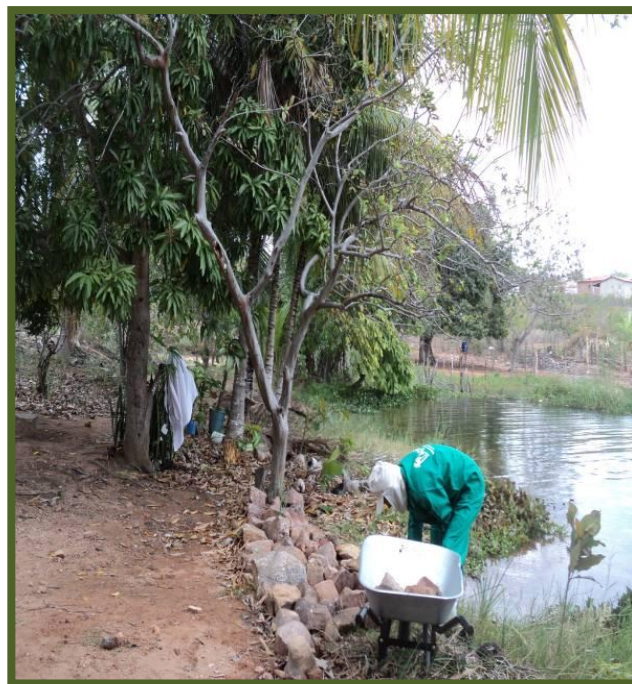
Enrocamento de pedra área 03 em setembro de 2011 (Flávio Santana).
